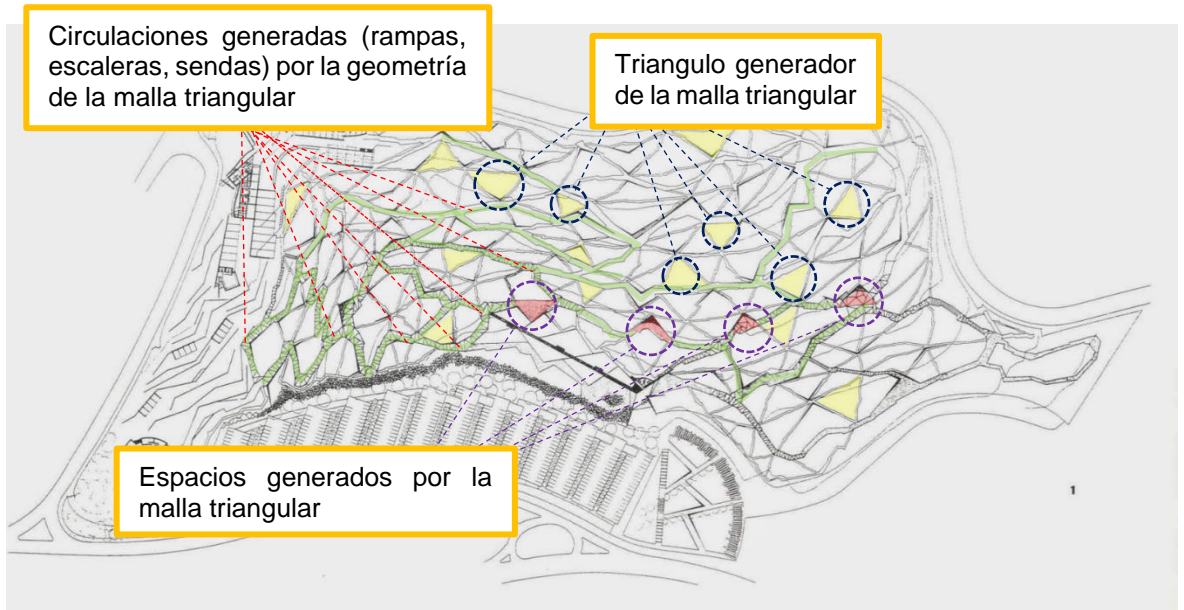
Vista en planta del Jardín Botánico de Barcelona
